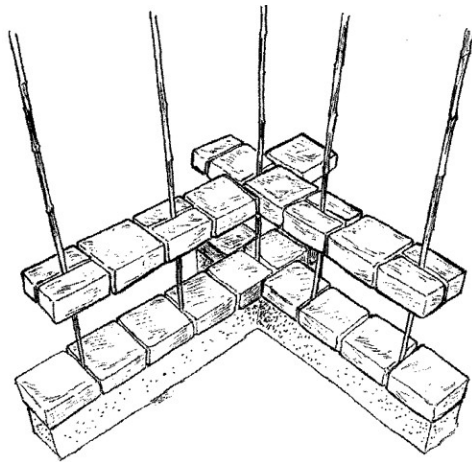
Cuatrapeado del sistema constructivo reforzado de adobe con caña de castilla. Fuente: Proyecto Taishin. El Salvador
